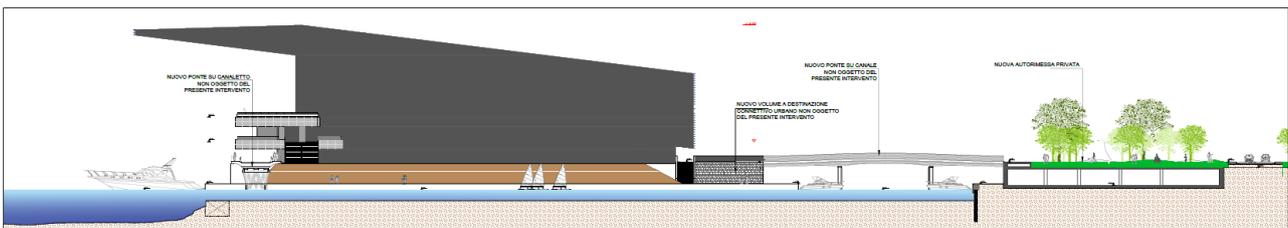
Sezione lungo il Canaletto e prospetto del Padiglione Nouvel (stralcio della tavola T08-D-Ar del Progetto Definitivo).
